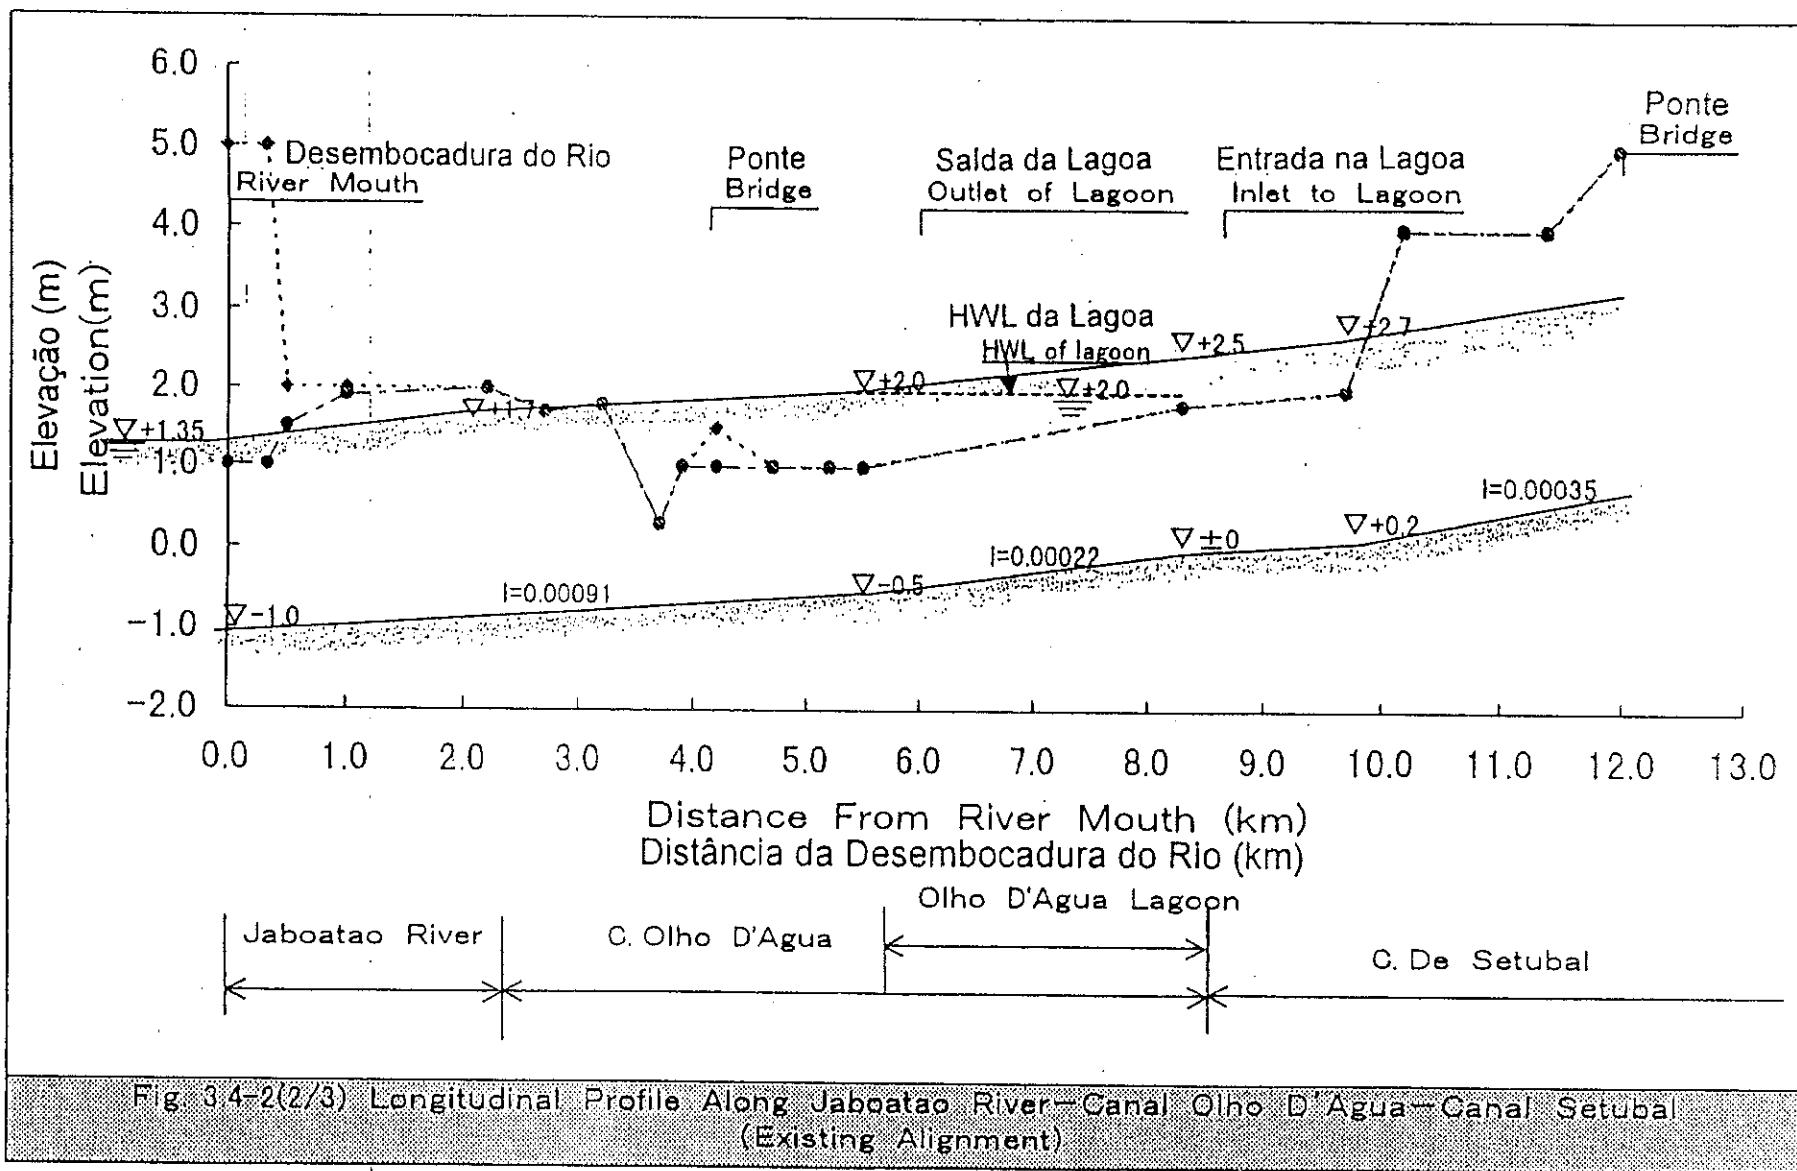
(2/3) Corte Longitudinal ao longo do Rio Jaboatão - Canal Olho D'Água - Canal Setúbal (Alinhamento Existente)
